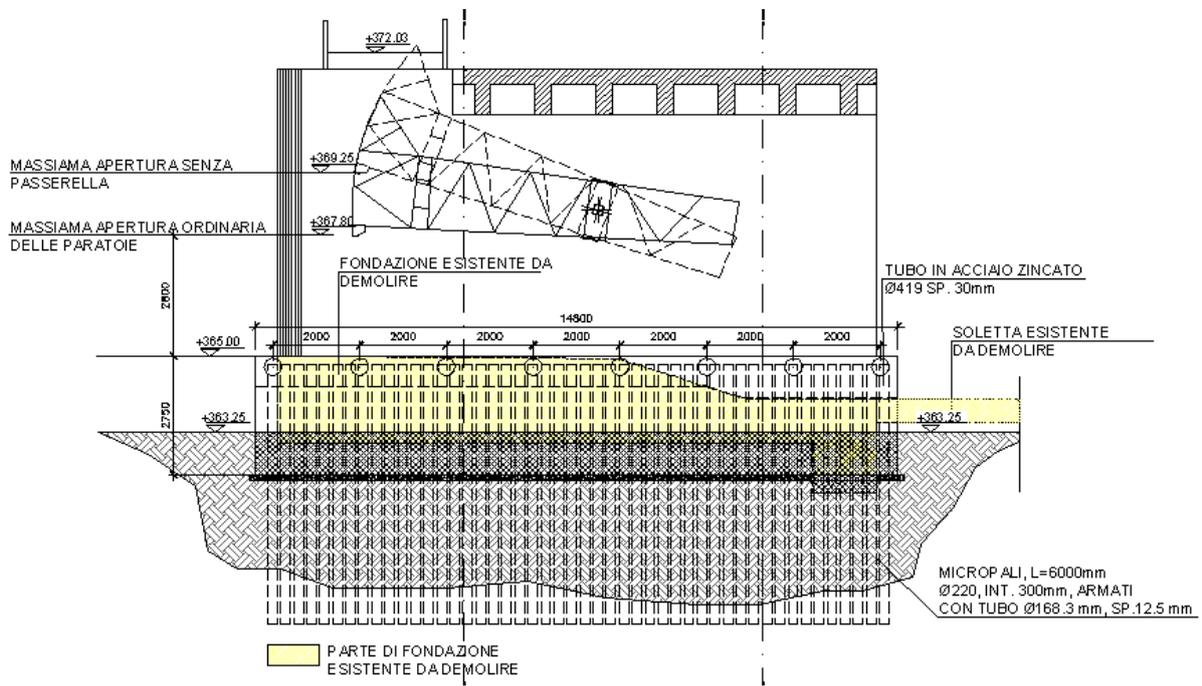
sezione longitudinale dell'intervento alla traversa esistente
